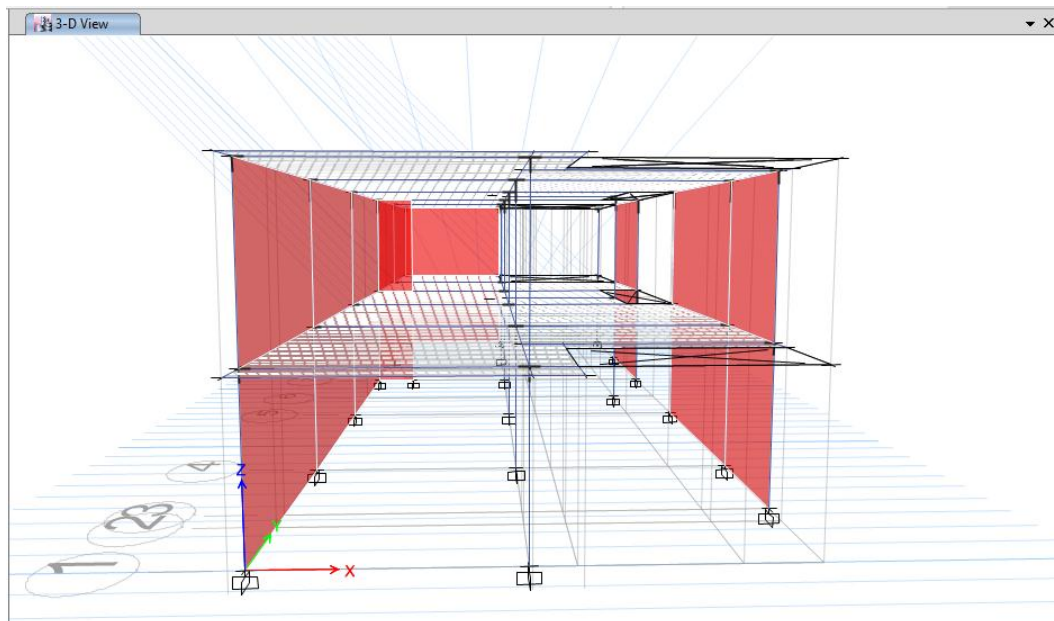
Vista tridimensional de la vivienda 3 reforzada con placa de concreto armado. Fuente: propia.
